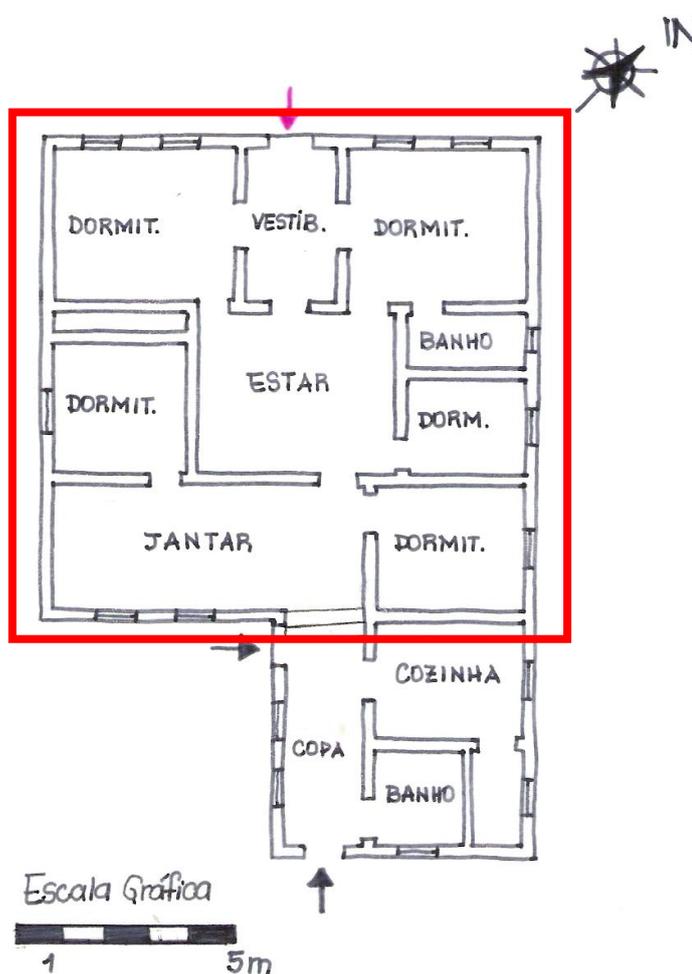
Planta baixa esquemática da edificação. Em destaque a planta baixa esquemática original da época de construção.
